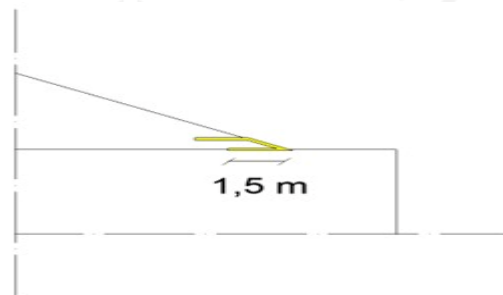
Detail Panjang Efektif Geotekstil Pada Timbunan 12m
